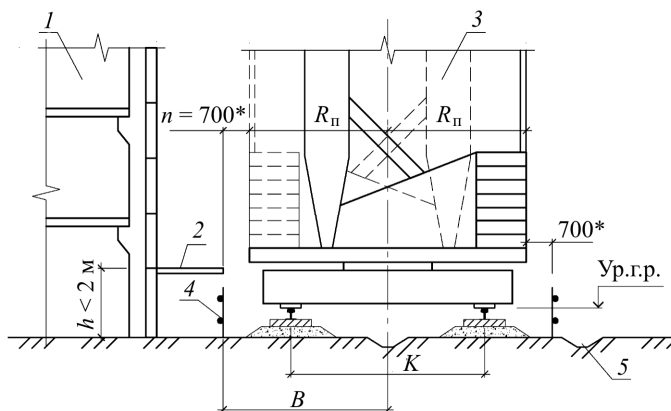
Поперечная привязка башенного крана с поворотной платформой к зданию: 1 – возводимое здание; 2 – выступающая часть здания (козырек) на высоте до 2 м; 3 – башенный кран; 4 – ограждение кранового пути; 5 – водосборная канава; $R_{\text{п}}$ – наибольший радиус поворотной части крана; * – расстояние указано от наиболее выступающей части крана
